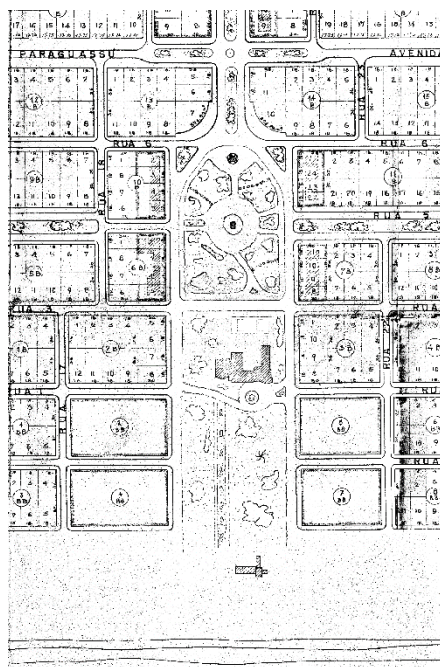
Detalhe da planta de Atlântida (1956), com o hotel, o mirante na beira da praia e um caminho pavimentado retilíneo entre eles. Fonte: Cláudia Casaccia – arquivo da ASAB
